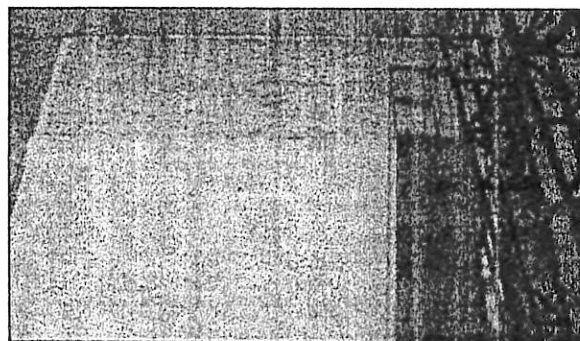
y 18.- Se observa humedad y grietas en el muro
